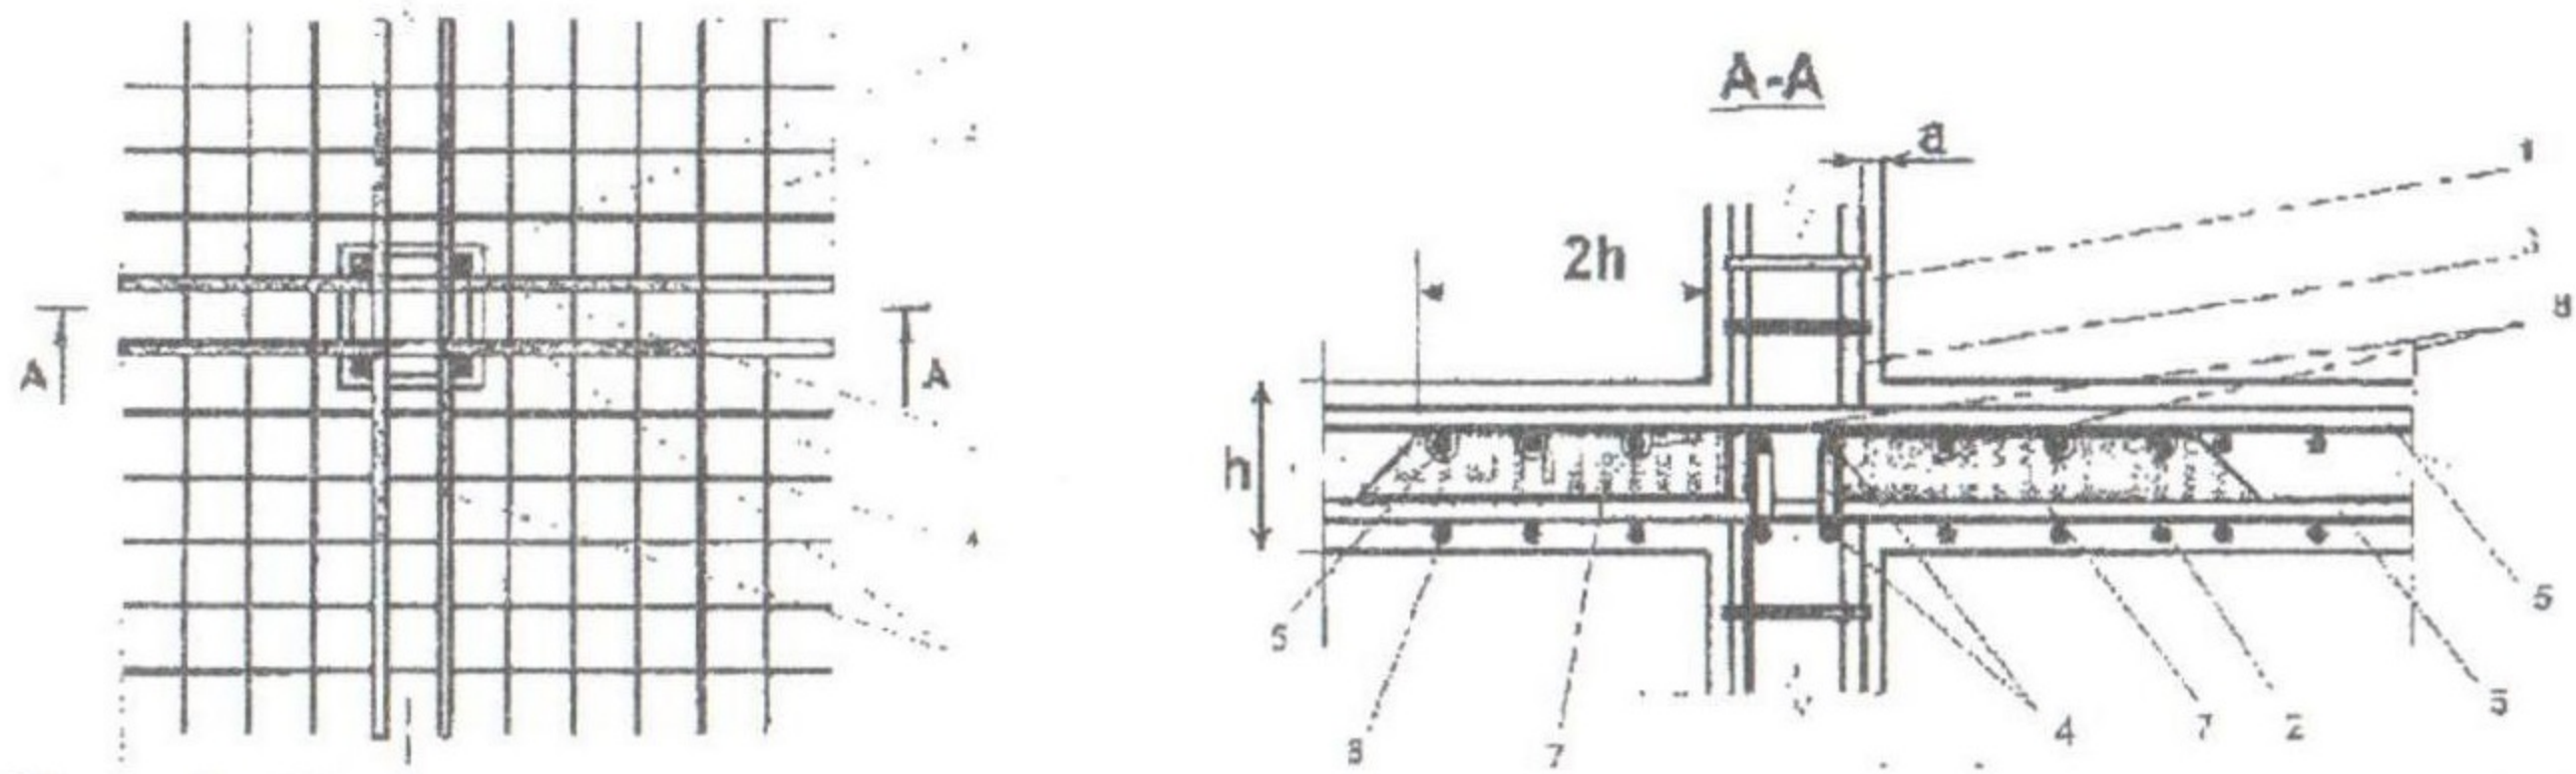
Узел соединения колонны с плитой перекрытия с использованием пластин: 1 – колонна; 2 – плита перекрытия; 3 – арматурный каркас колонны; 4 – арматурный каркас плиты перекрытия; 5 – верхняя сетка; 6 – нижняя сетка; 7 – пластина; 8 – отверстия в пластине
